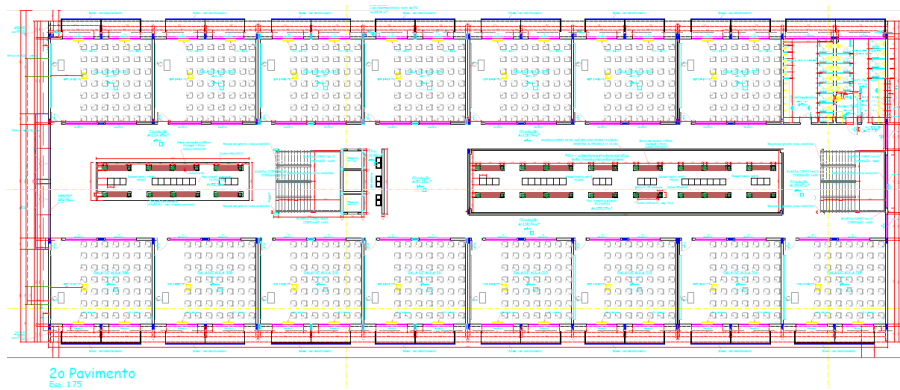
Projeto executivo, segundo pavimento – Bloco VI.
